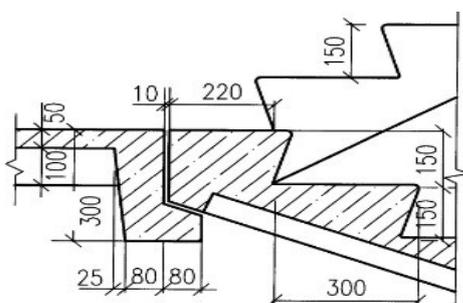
Узел сопряжения сборной железобетонной лестничной площадки и сборного железобетонного лестничного марша ребристой конструкции
